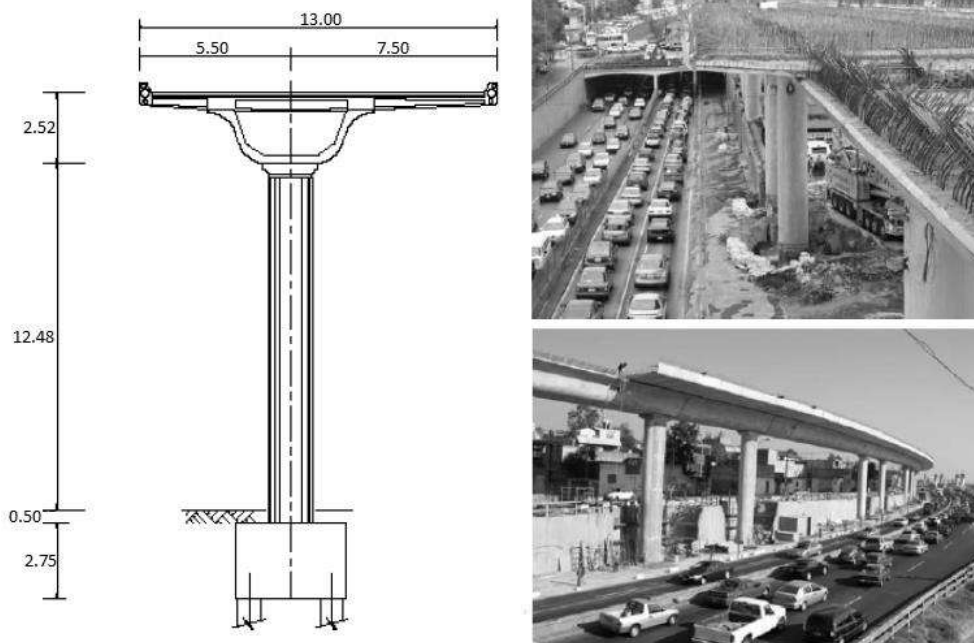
Elevación de columnas y calzada (metros). Fotografías de los tramos en estudio.
